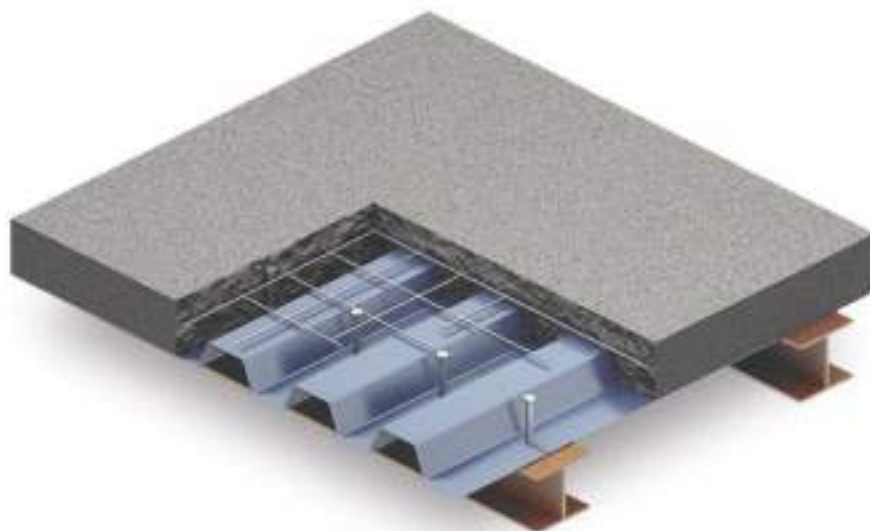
Exemplo de laje mista sobre viga metálica – Steel deck
